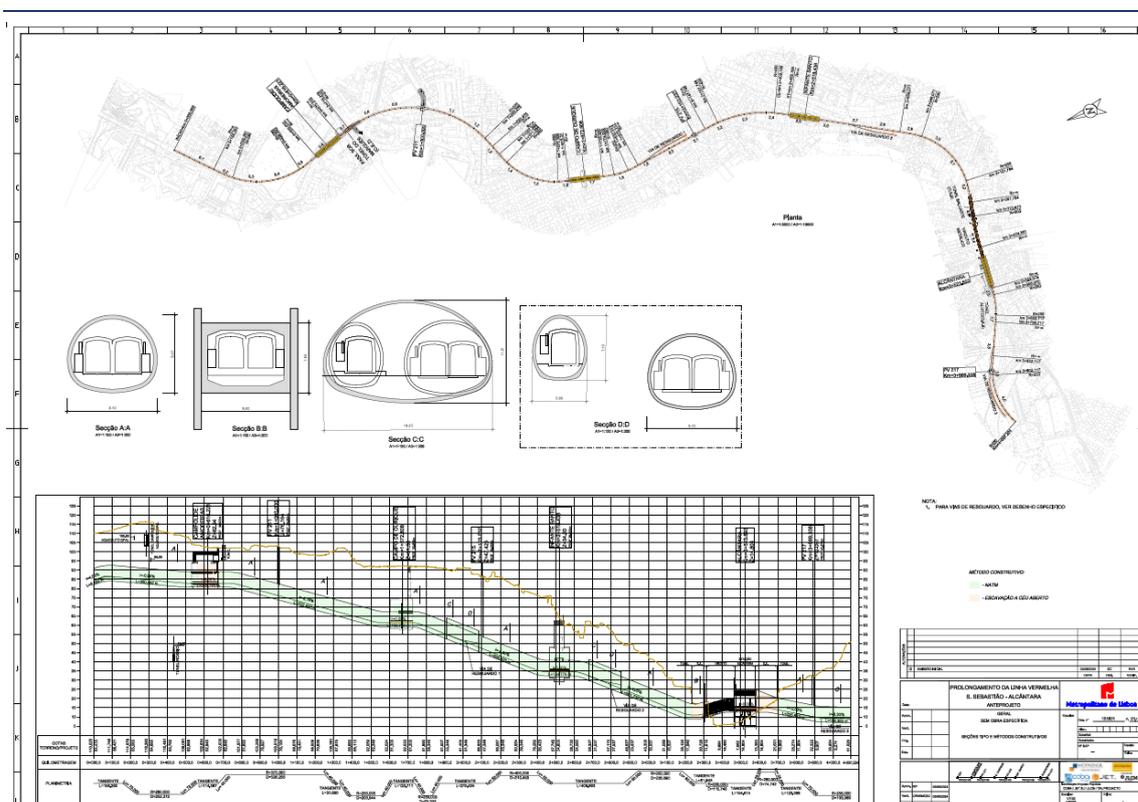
Planta e Perfil Longitudinal – Excerto do desenho do PE – LVSSA MSA PE GER LIN 000 DW 010001 0
